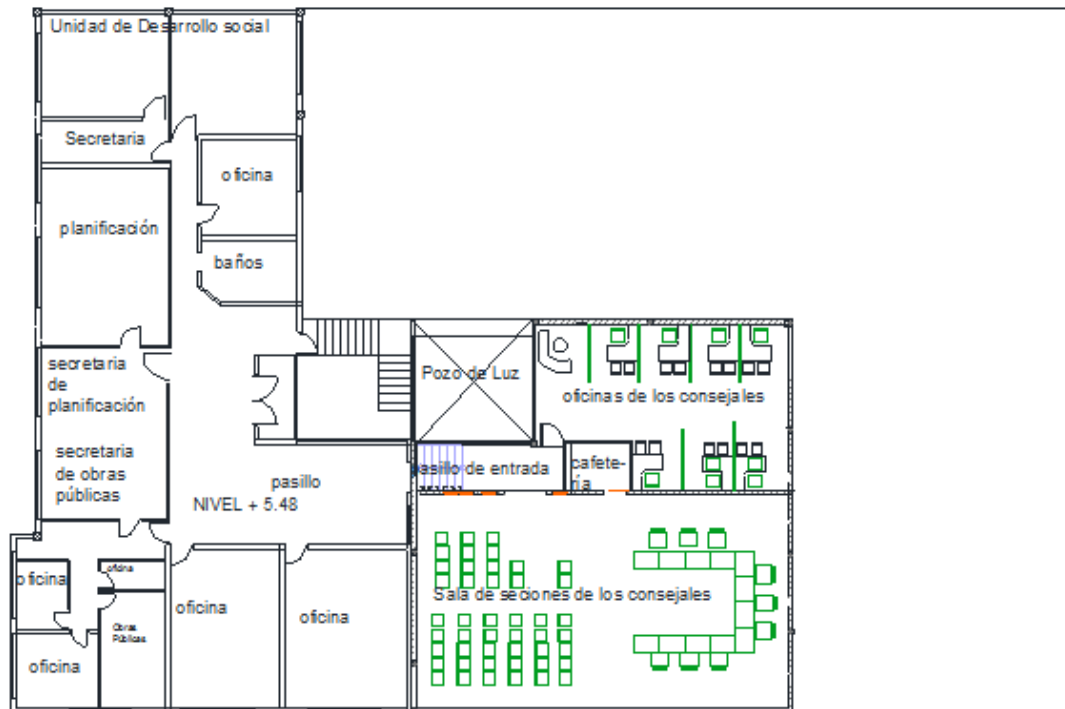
Planos de la Tercera Planta y su Distribución
